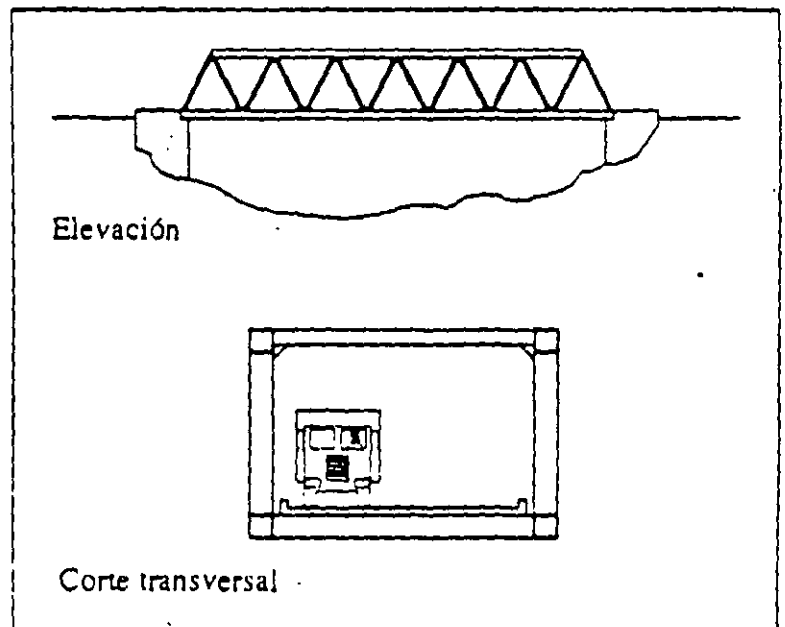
Sección transversal, tipo 40, Armadura u Paso Inferior
